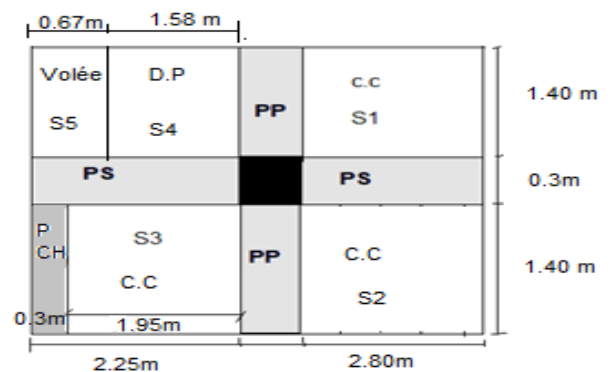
Surface afférente du poteau D2 (T.I + E.C)
